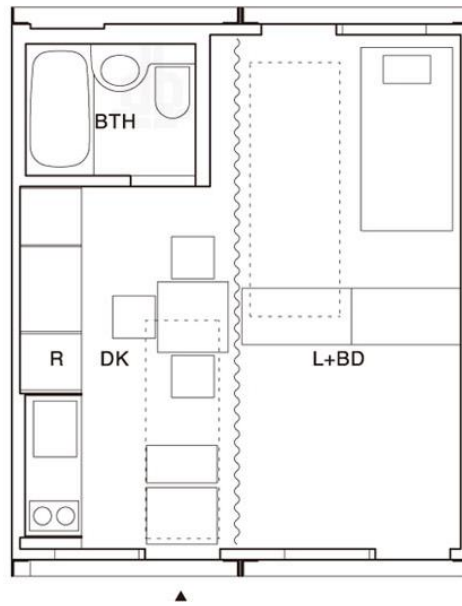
Vista en planta del proyecto Ex Container. (Design Boom, 2013)
